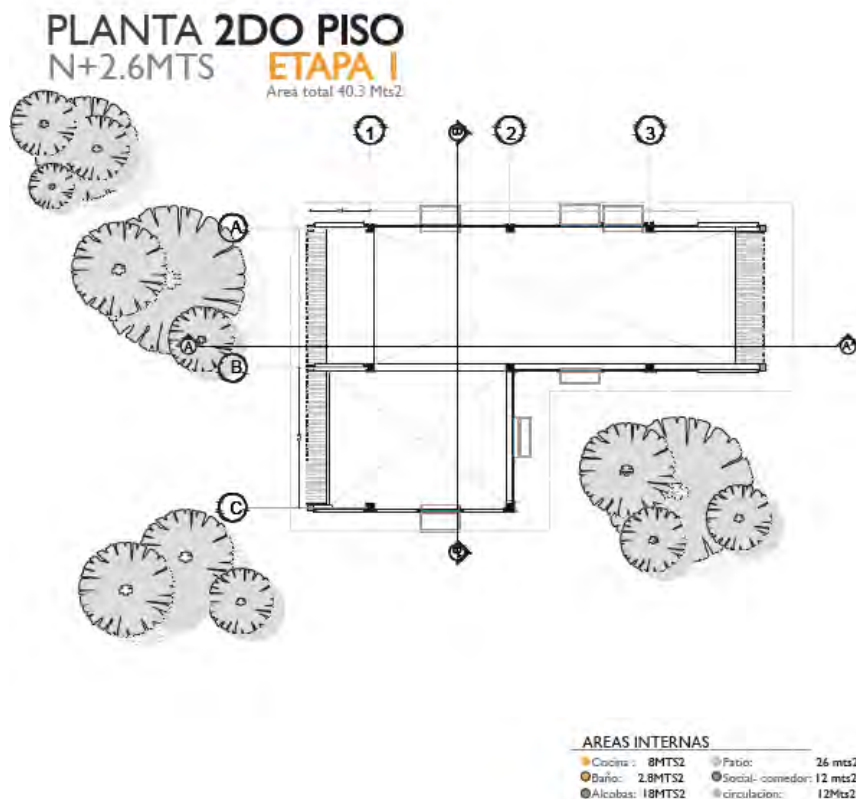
Planta 2 piso, primera etapa vivienda A I Fuente: propia
